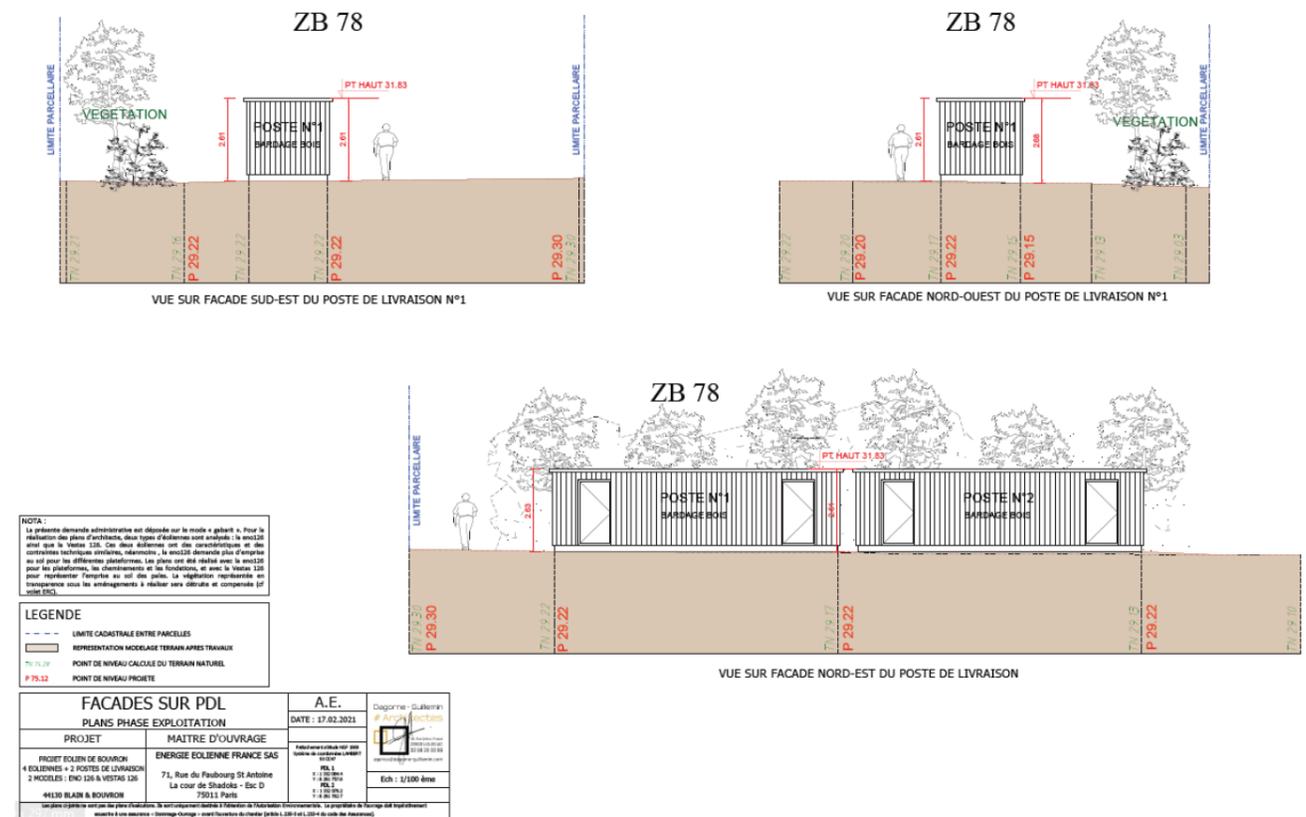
Plan des postes de livraison (Source : EEF SAS)
